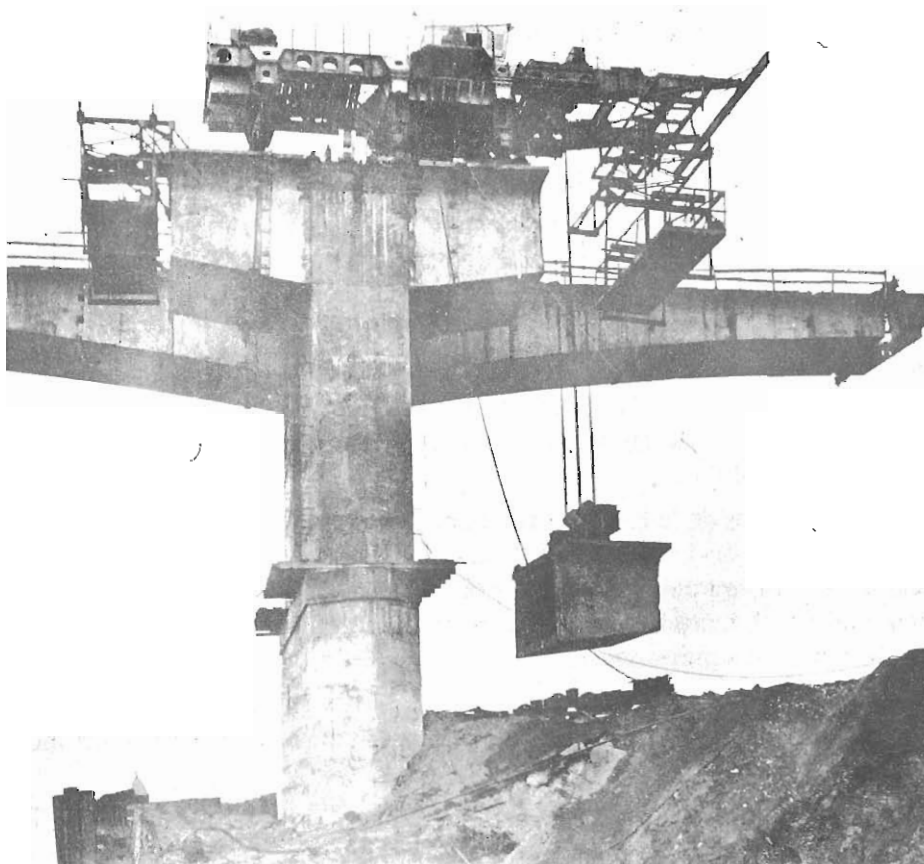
Puente sobre el Oka en Ryazan. Sistema constructivo.
